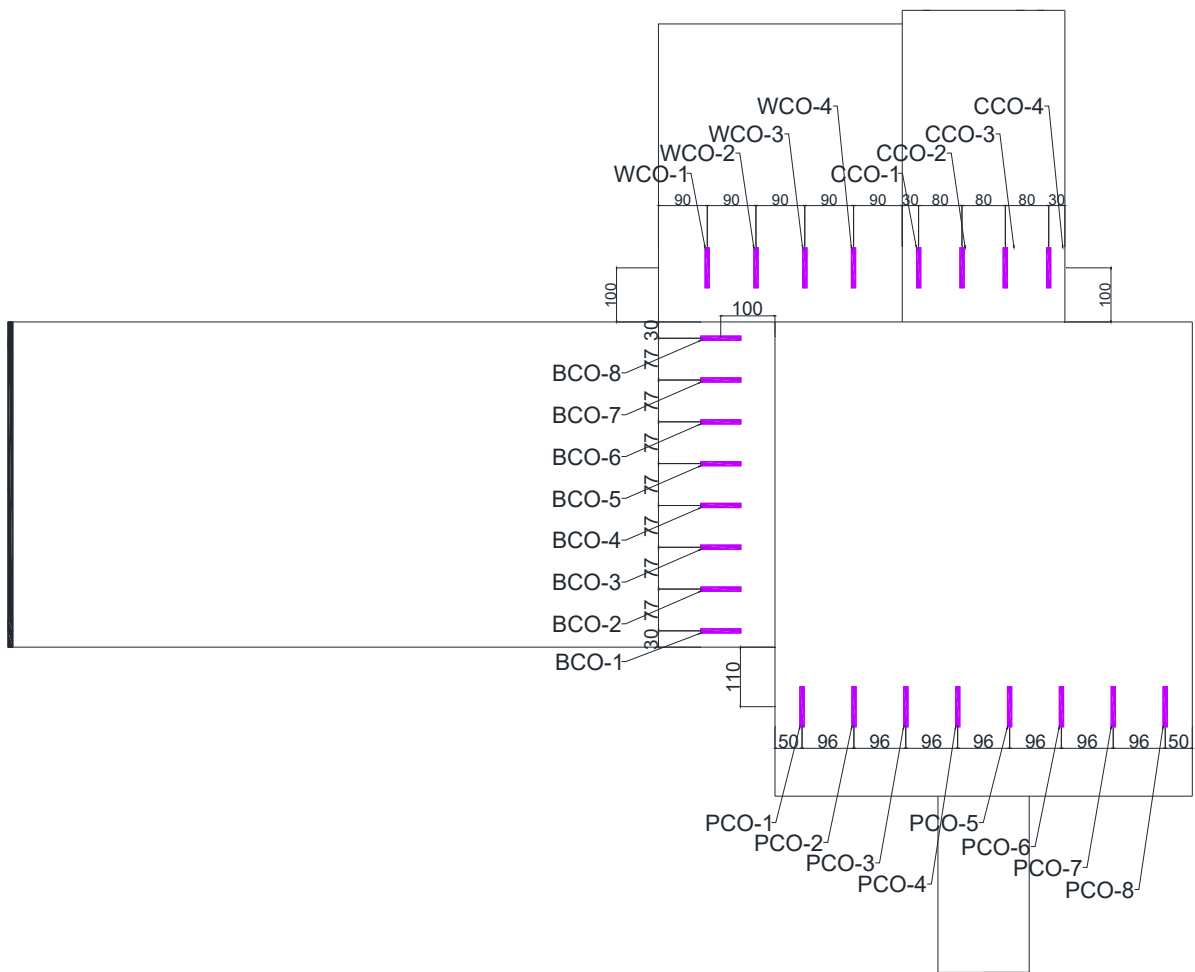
コンクリート表面 歪みゲージ貼付図（東側立面図）
